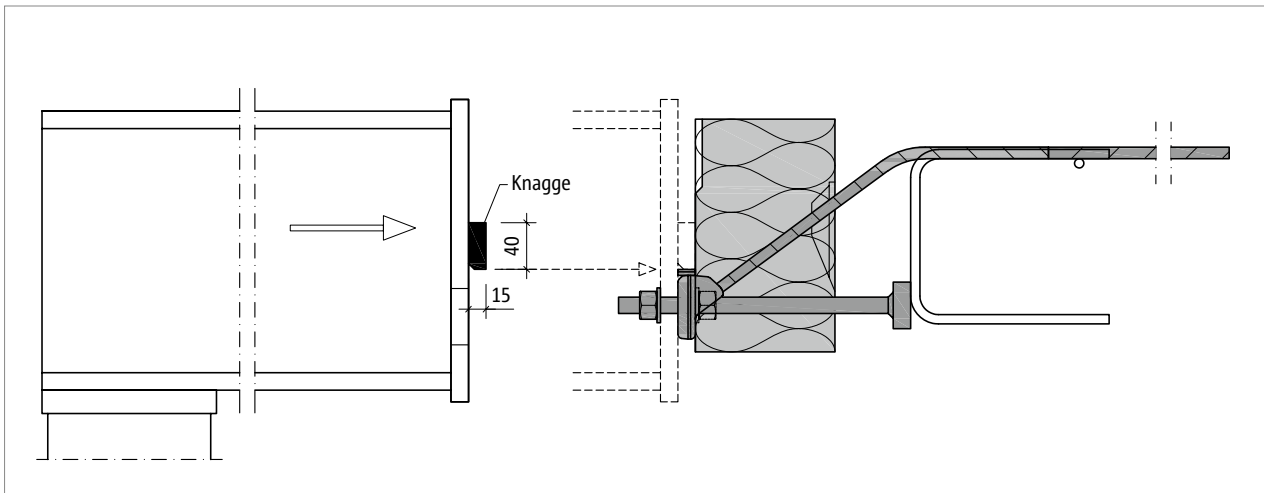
Schöck Isokorb® XT Typ SQP: Montage des Stahlträgers
